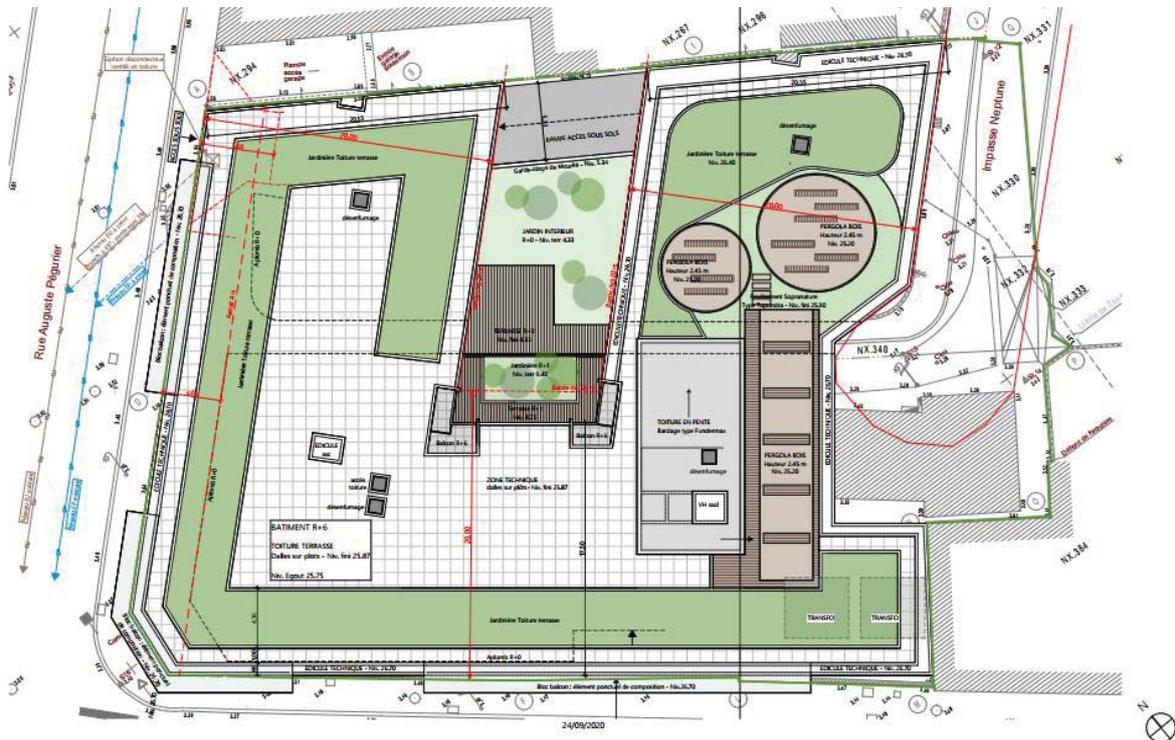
Plan de toiture provisoire (source : Atelier DP Architecture)
